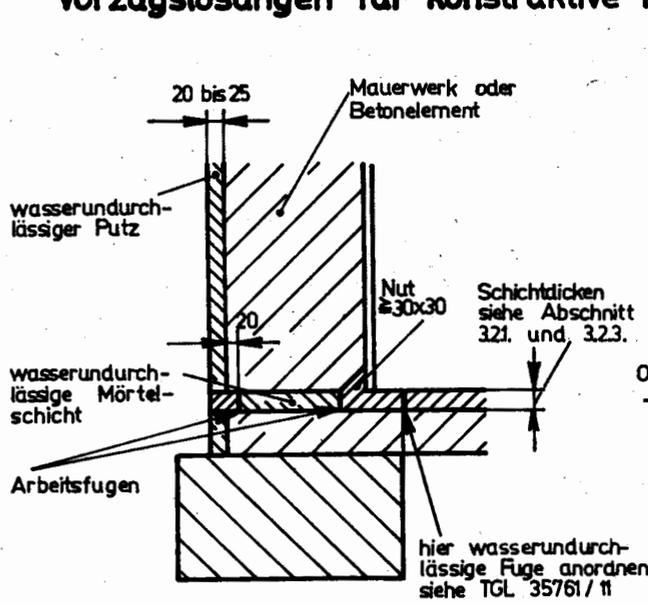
Bauwerksabdichtung einer Kelleraußenwand und Kellerfußboden aus wasserundurchlässigem Mörtel und Estrich
